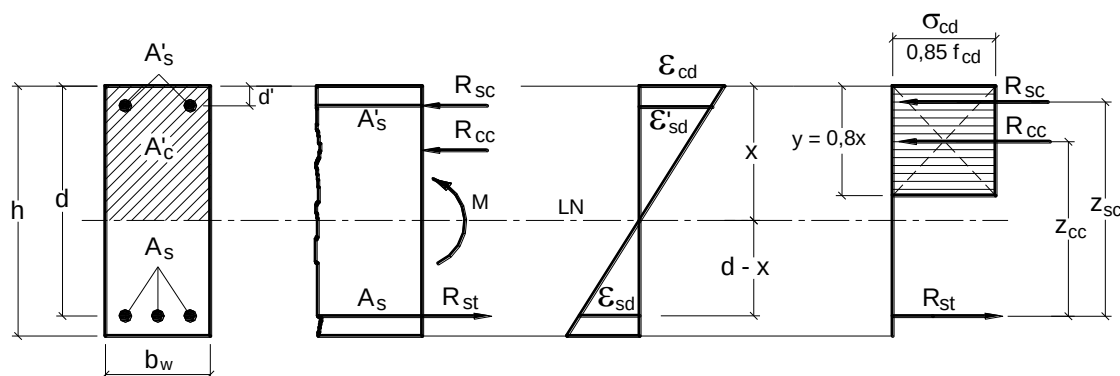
Seção retangular com armadura dupla, para concretos do Grupo I.
